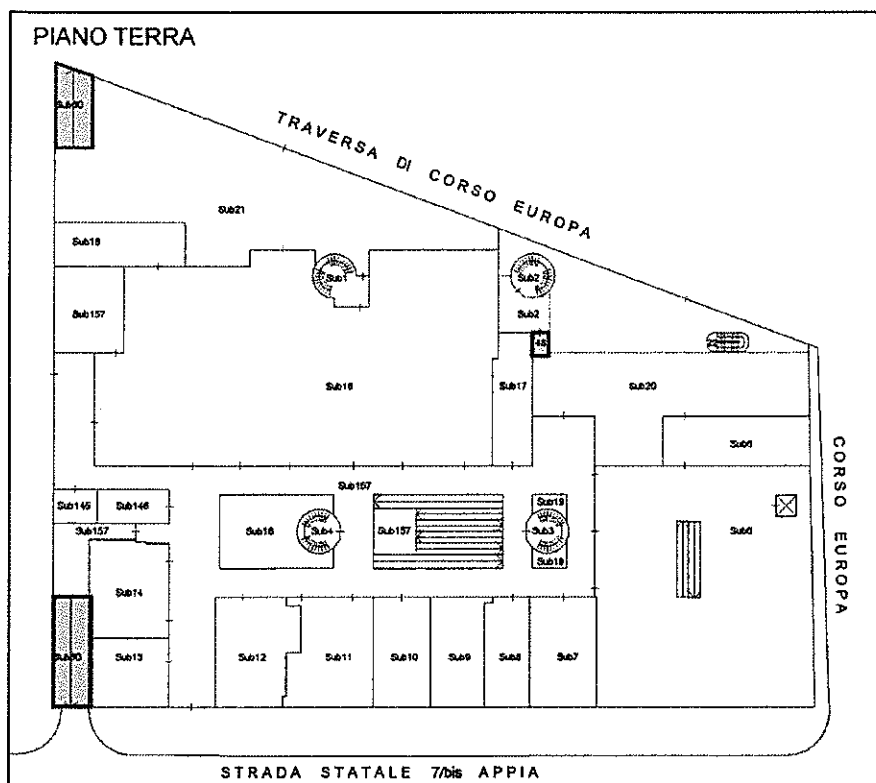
Elaborato planimetrico piano T. Individuazione dei subalterni 48 (porzione) e 60 (rampe).
